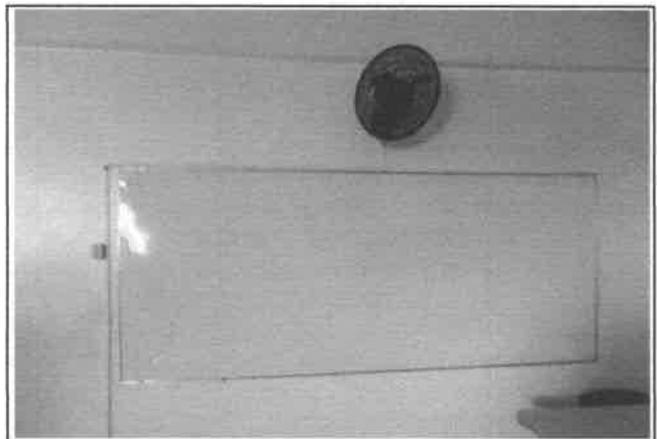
REVESTIR PAREDES SALAS DE AULA BLOCO ANEXO
